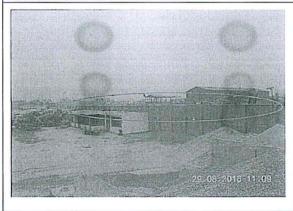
Vista de la pared lateral cerca al área de mantenimiento de la planta no cuenta con malla rashel
